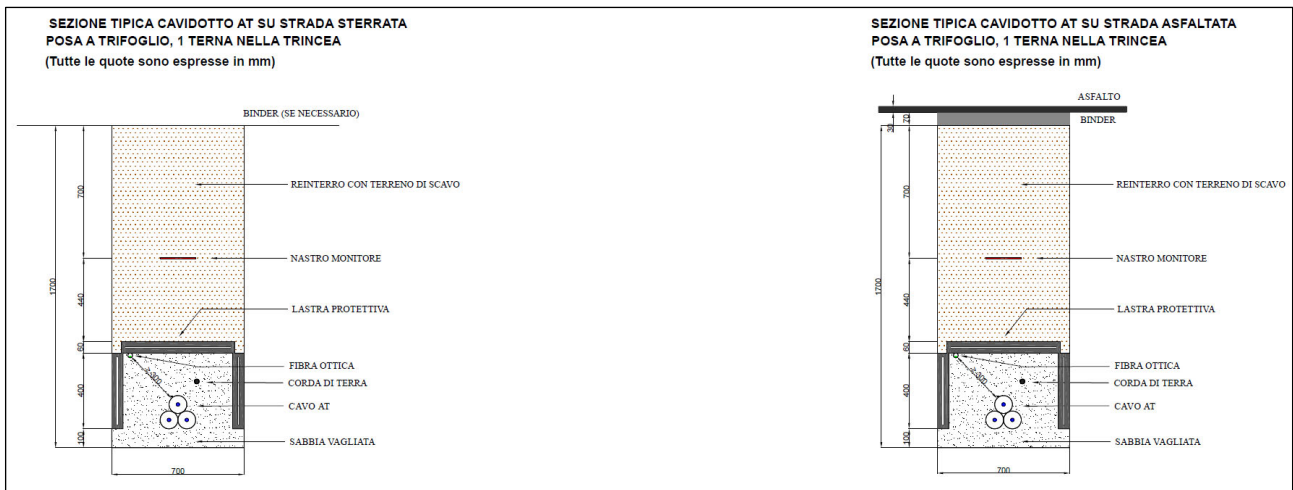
Sezione tipica dei cavidotti AT su strada sterrata e asfaltata
